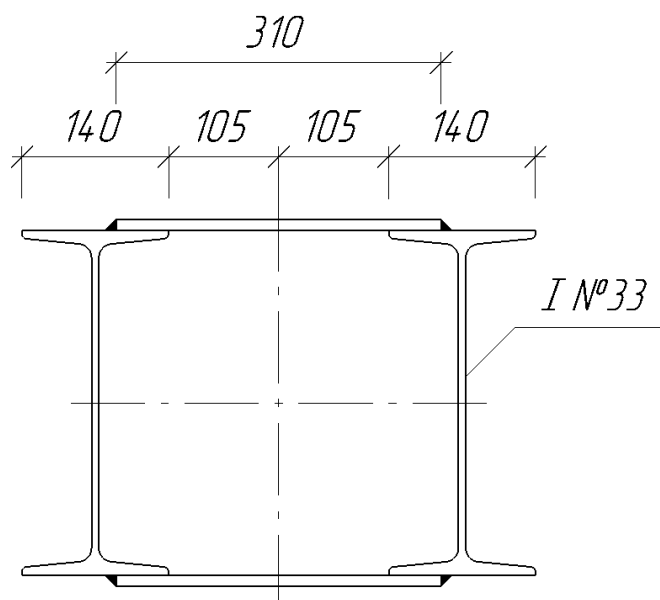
Поперечное сечение колонны сквозного сечения
